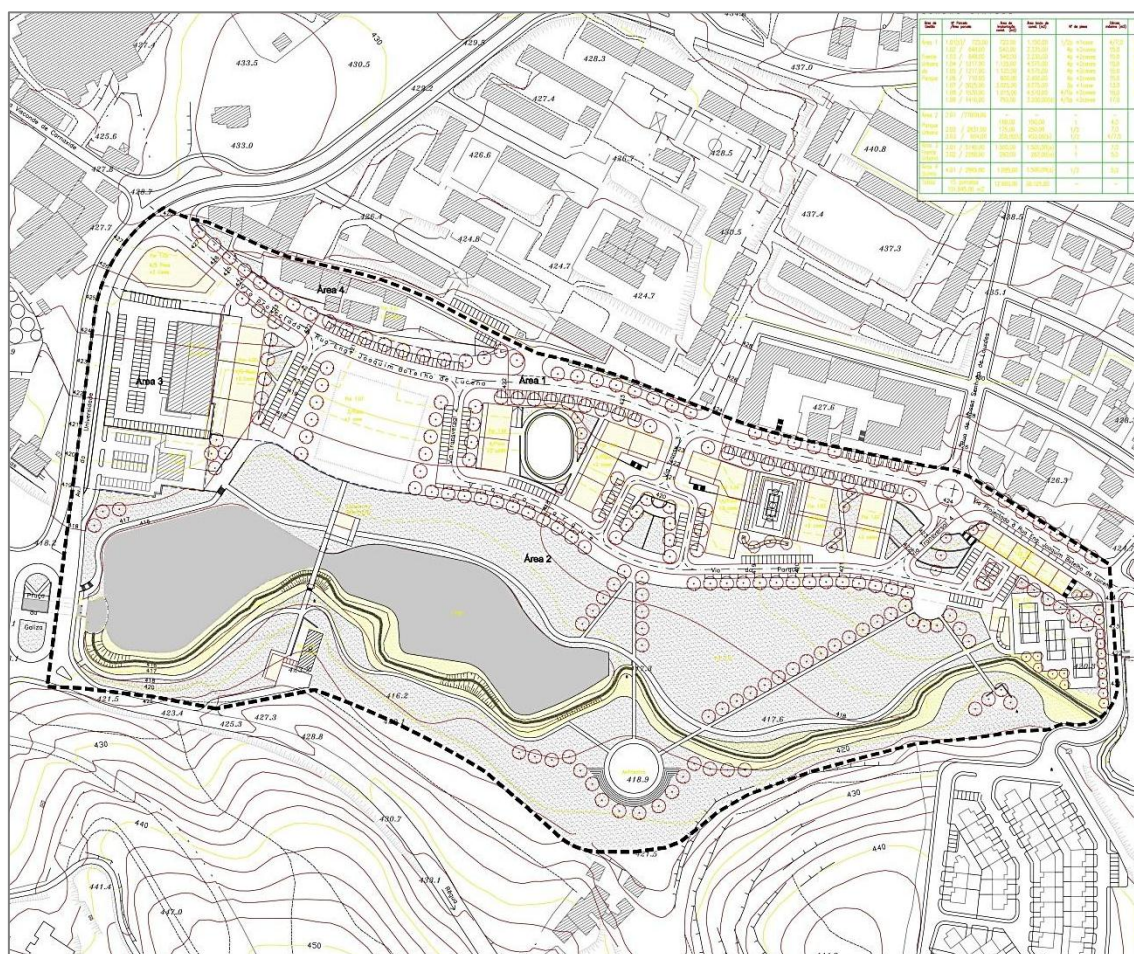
Extracto da Planta de Implantação do PPT e Legenda (2003)
